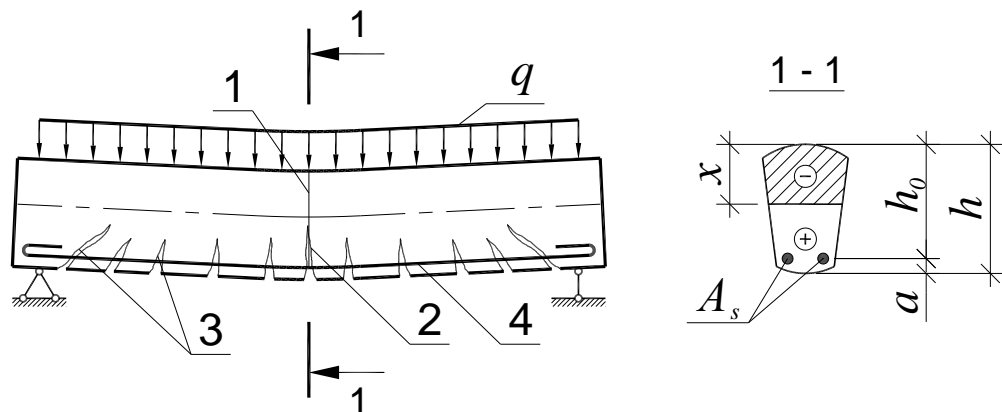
К расчету изгибаемых элементов: 1 – нормальное сечение 1 – 1; 2, 3 – соответственно нормальные и наклонные трещины; 4 – продольная рабочая арматура.
